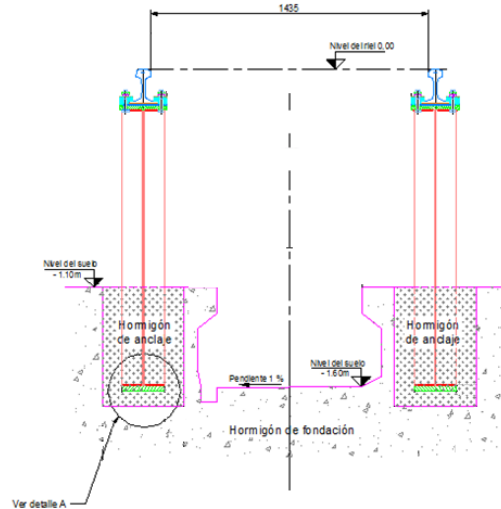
Vía férrea sobre pilotes (vías taller). Fuente: Elaboración propia
